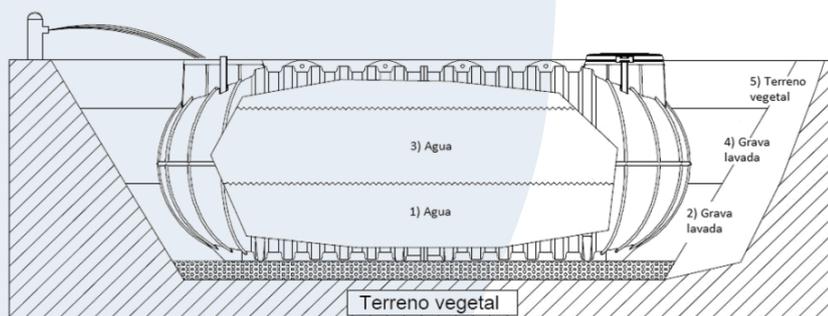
Ilustración II: Capas de relleno a distribuir para el soterramiento del equipo.
